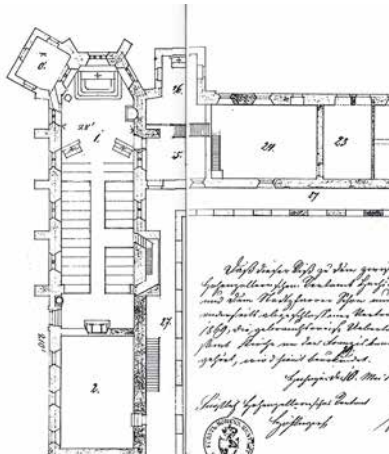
Stetten bei Hechingen, Kloster, Grundriss, EG, 1869
